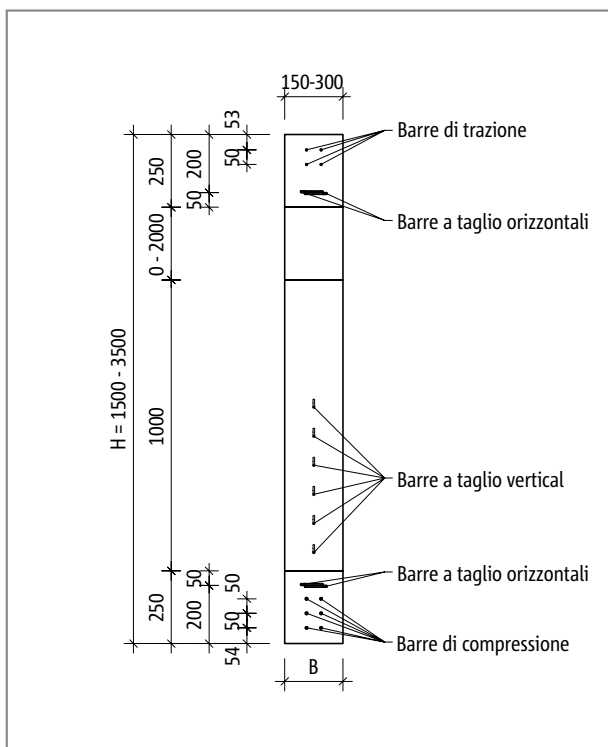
Schöck Isokorb® tipo WXT1: vista dell'elemento
